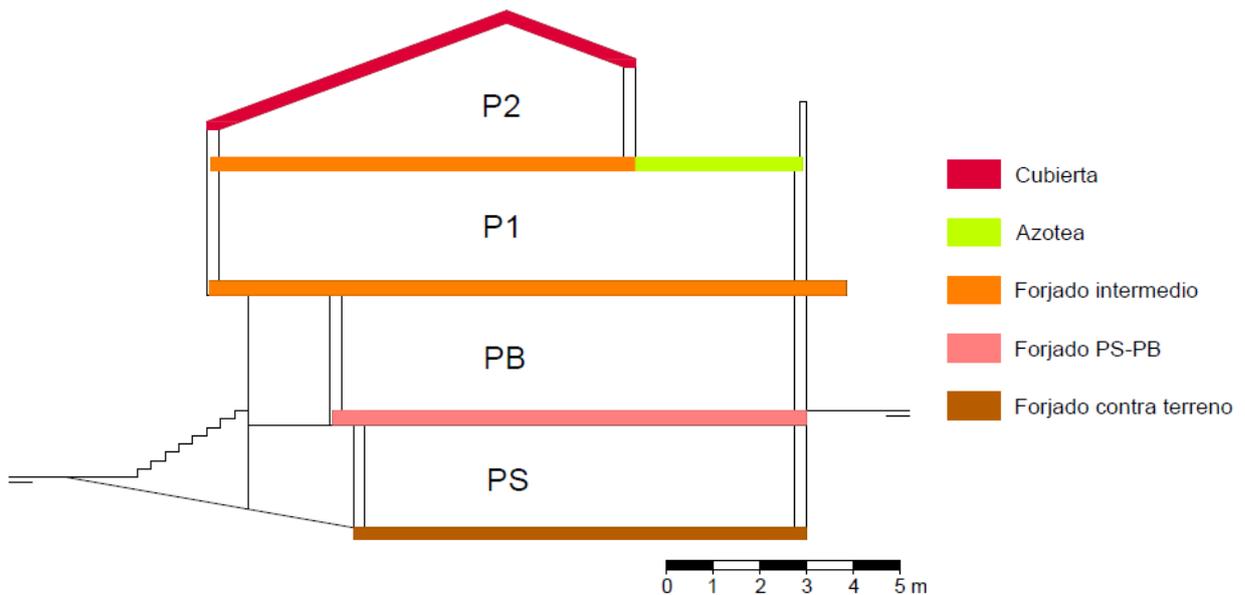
Sección con elementos constructivos vivienda unifamiliar Picanya (Valencia).
